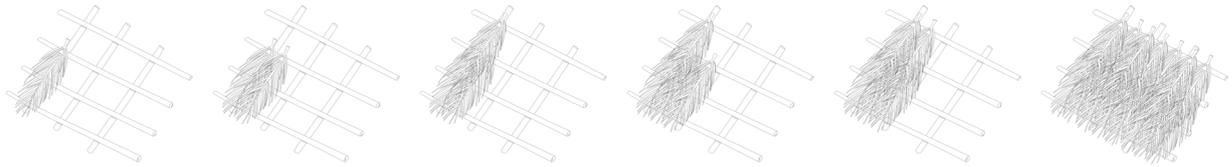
Esquema de la colocación de la hoja de guano en una cubierta.
